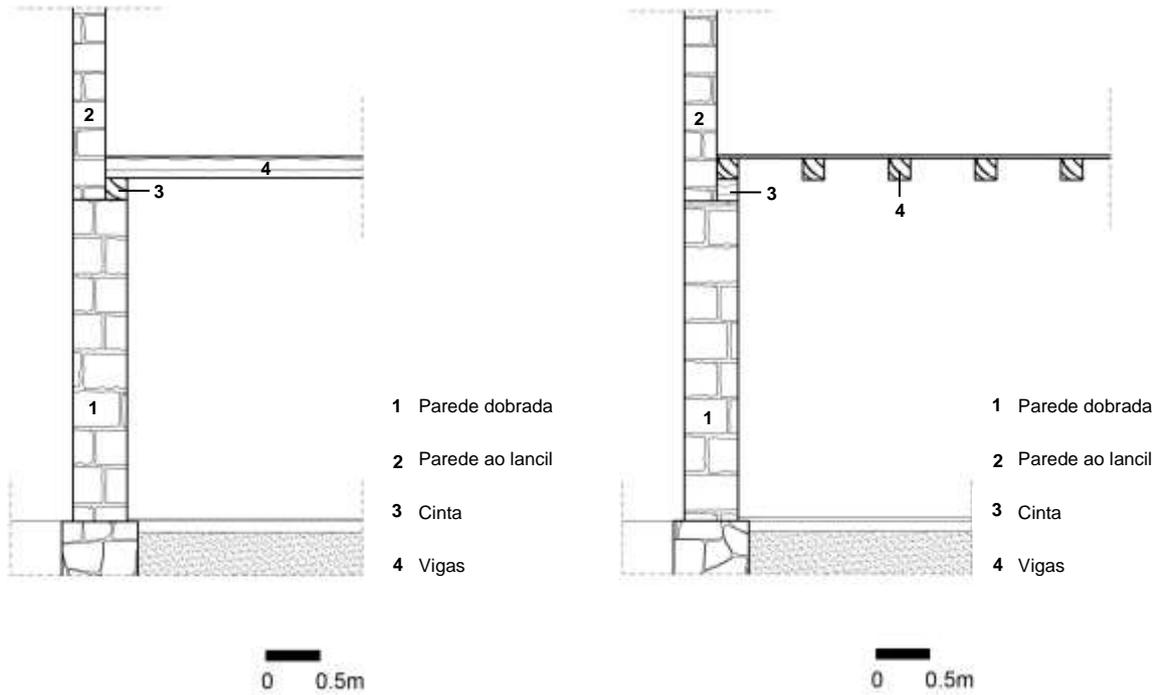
Pormenor de corte longitudinal com parede mista (dobrada em baixo, ao lancil em cima). (Ilustração nossa, 2021)
